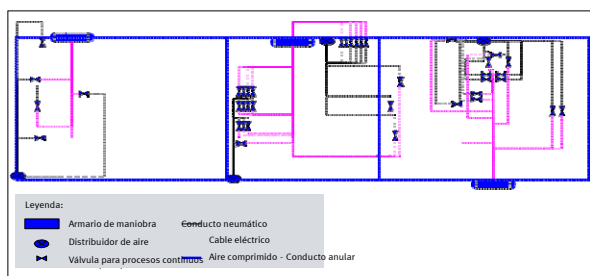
representación detallada de la planta baja – Válvulas individuales.
